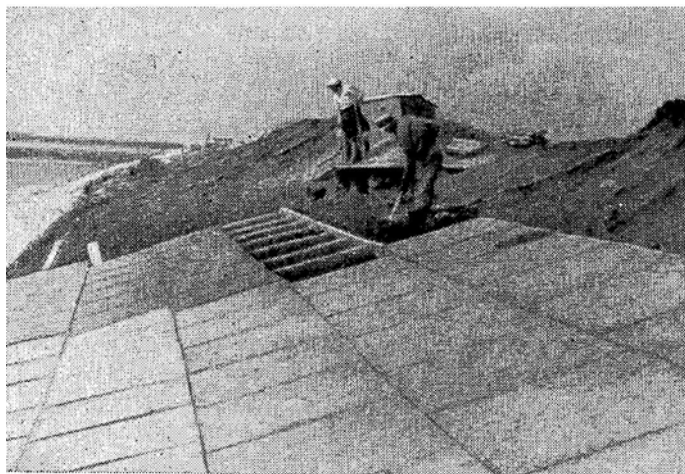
Устройство креплений верхового откоса из бетонных плит
